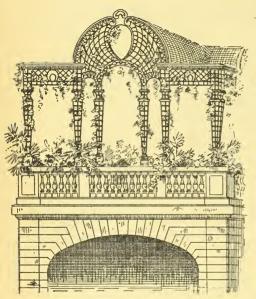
Façade en treillage du Pavillon Moët et Chandon.
